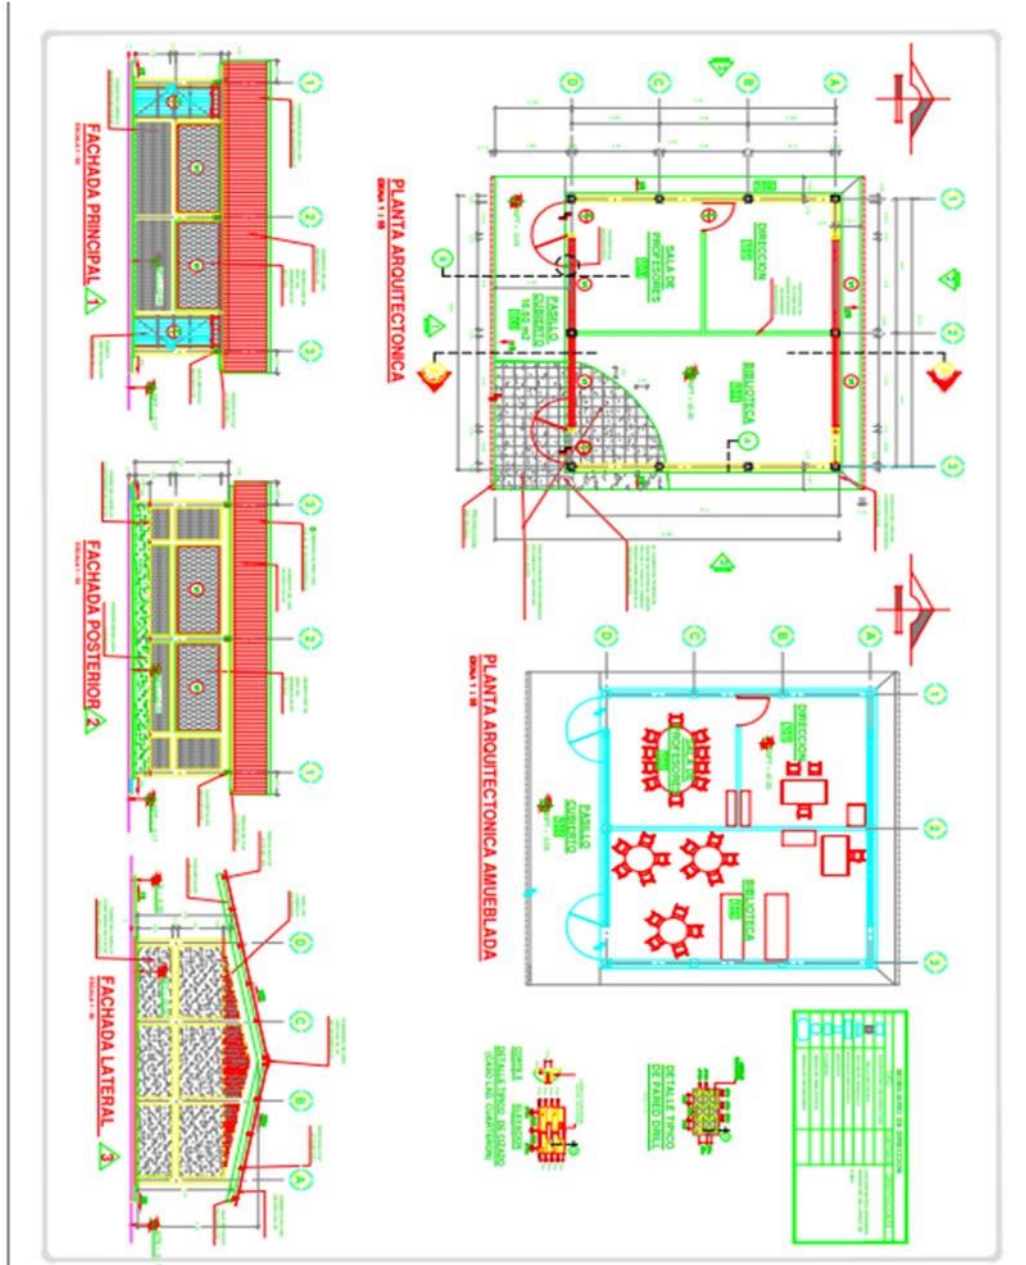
Planta arquitectónica Sector dirección y biblioteca
